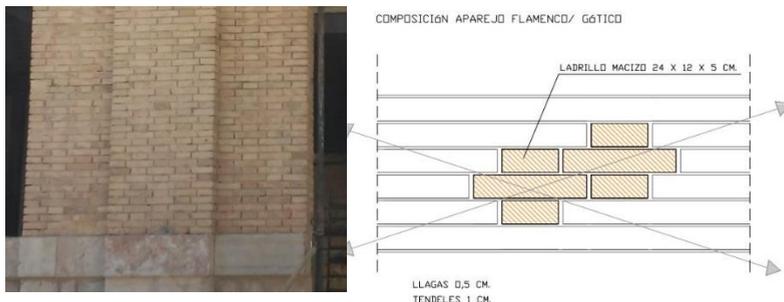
Imagen y croquis muro fachada y composición aparejo flamenco Nave 1. Figuras propias 2016
